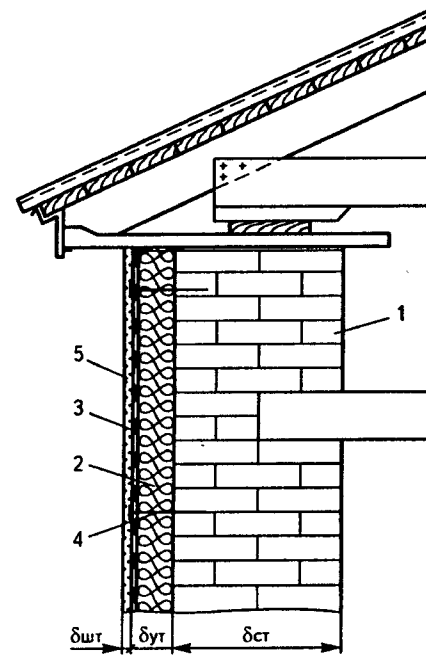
Утепление кирпичной стены здания минераловатными плитами со штукатурным покрытием по системе «Фасолит». Узел примыкания к карнизу:
